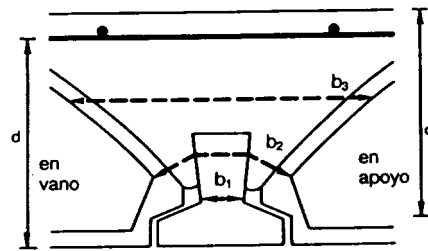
Anchos para comprobar el esfuerzo cortante en vigüetas armadas sin armadura transversal.
